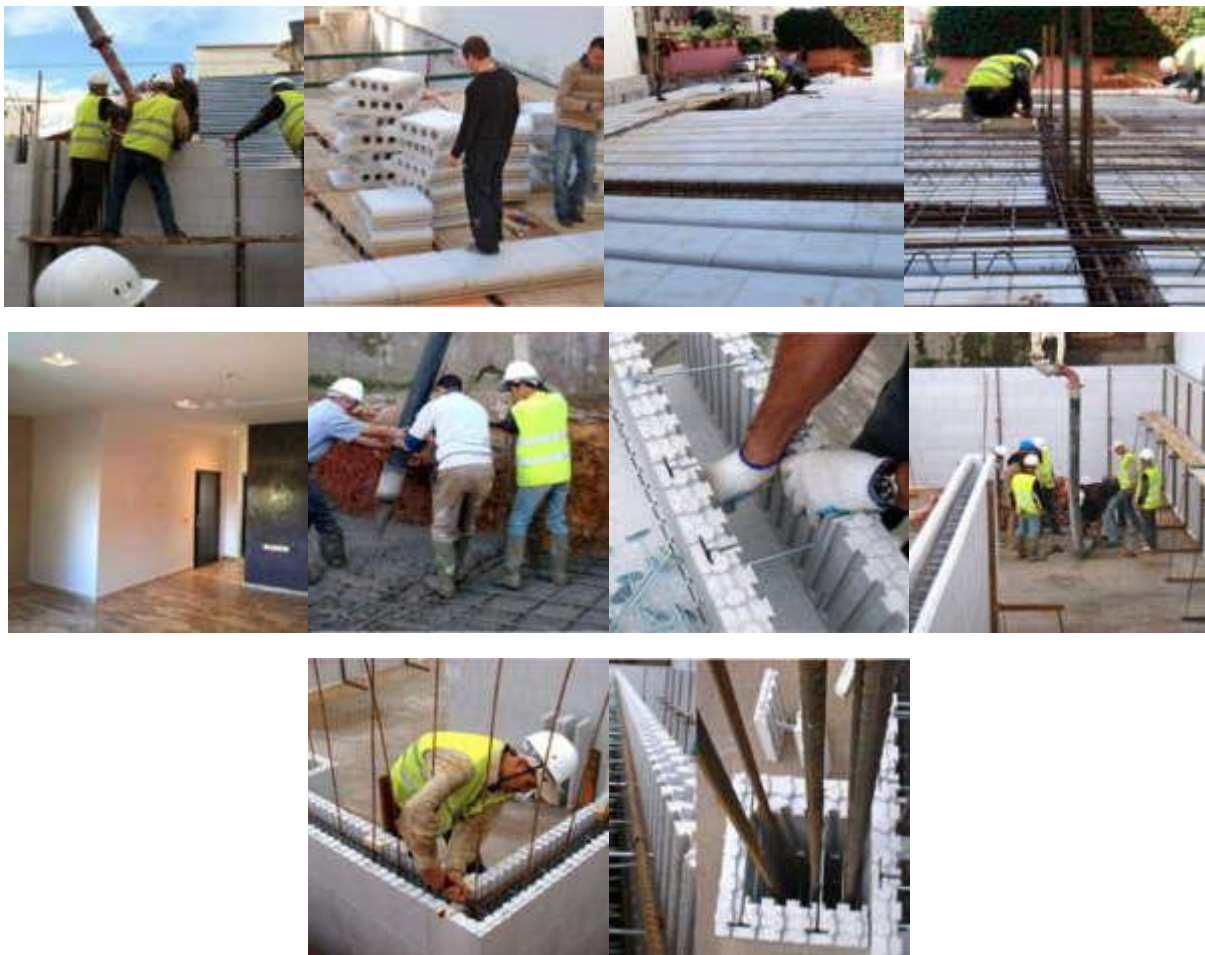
Aperçu de l'utilisation du PSE dans la construction (photos de IsodurHouse)
